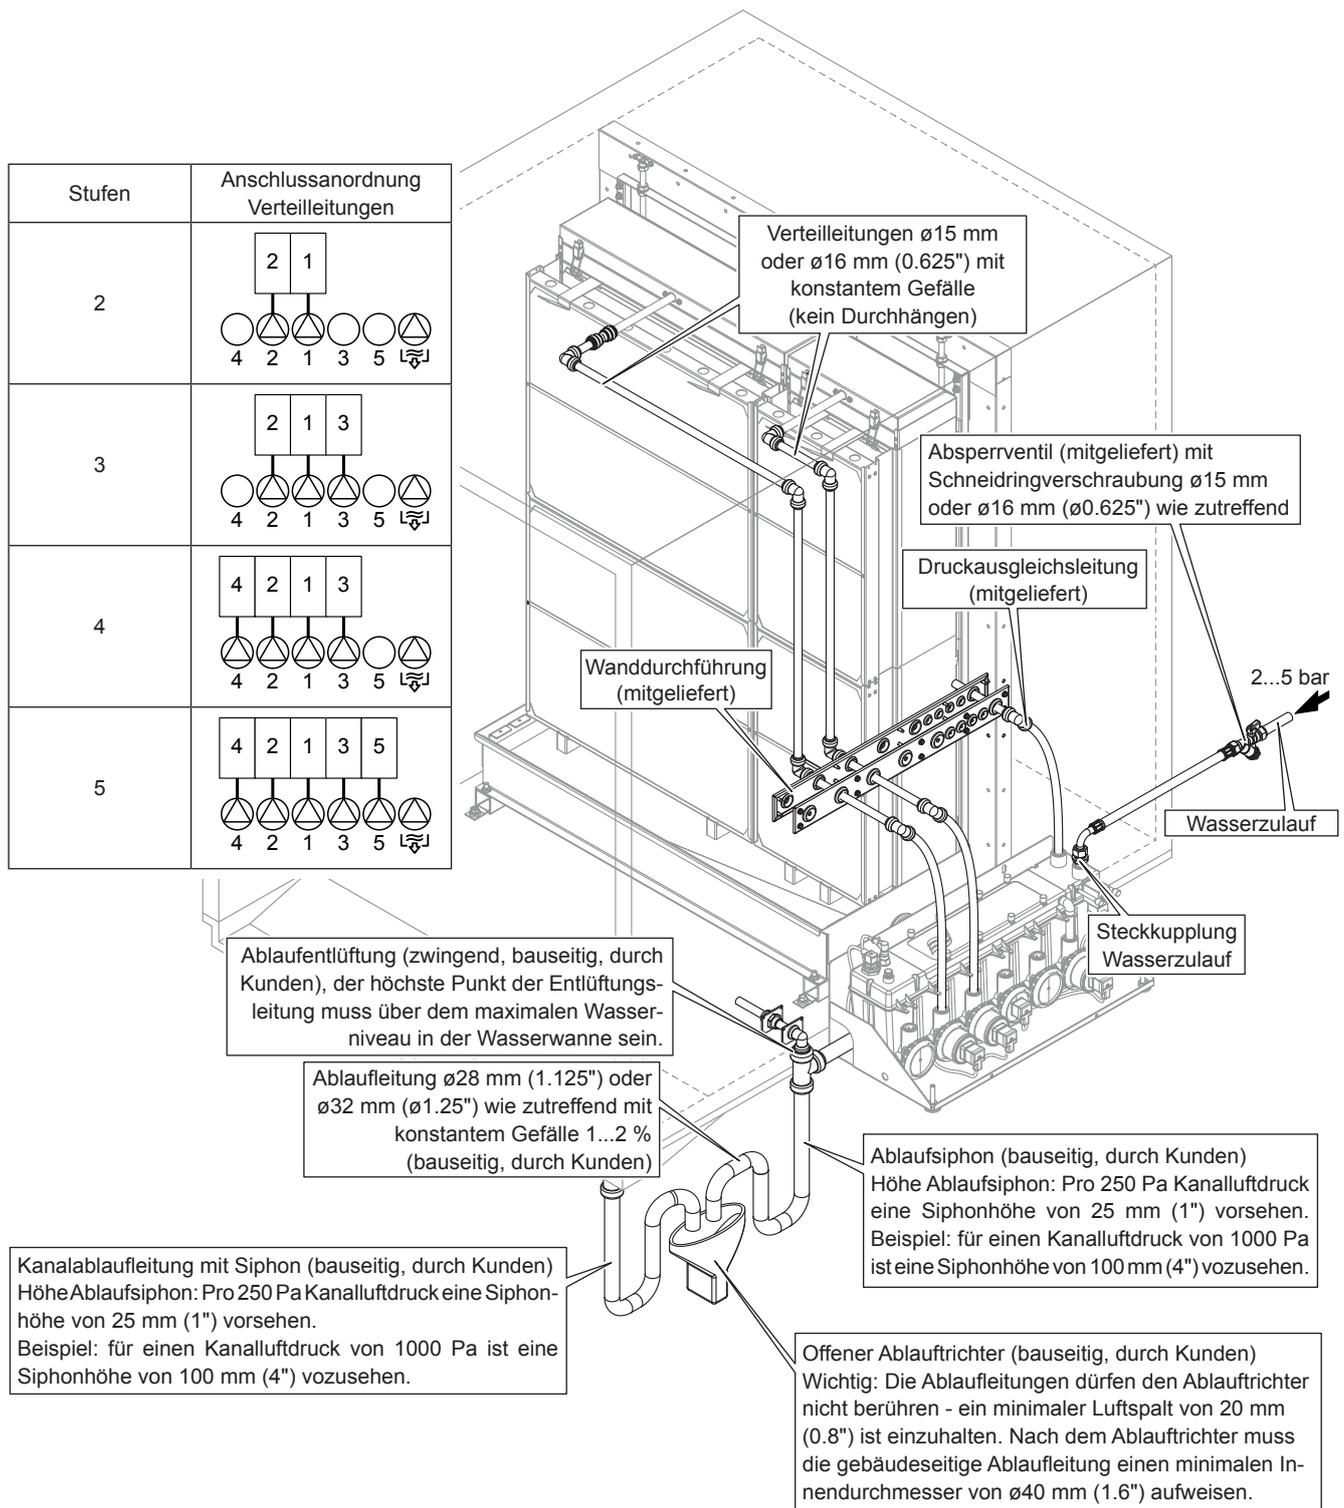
Wasserinstallation für Systeme mit Wassertank mit Seitenablauf und einem Hydraulikmodul, Aussenmontage
